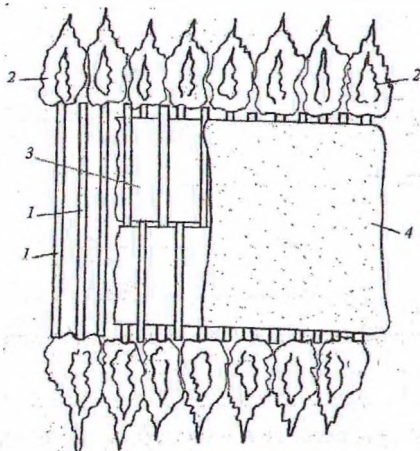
Дорожная конструкция с деревянным настилом и ГМ: 1 – верхняя часть дерева; 2 – крона; 3 – рулонный ГМ; 4 – грунт земляного полотна
